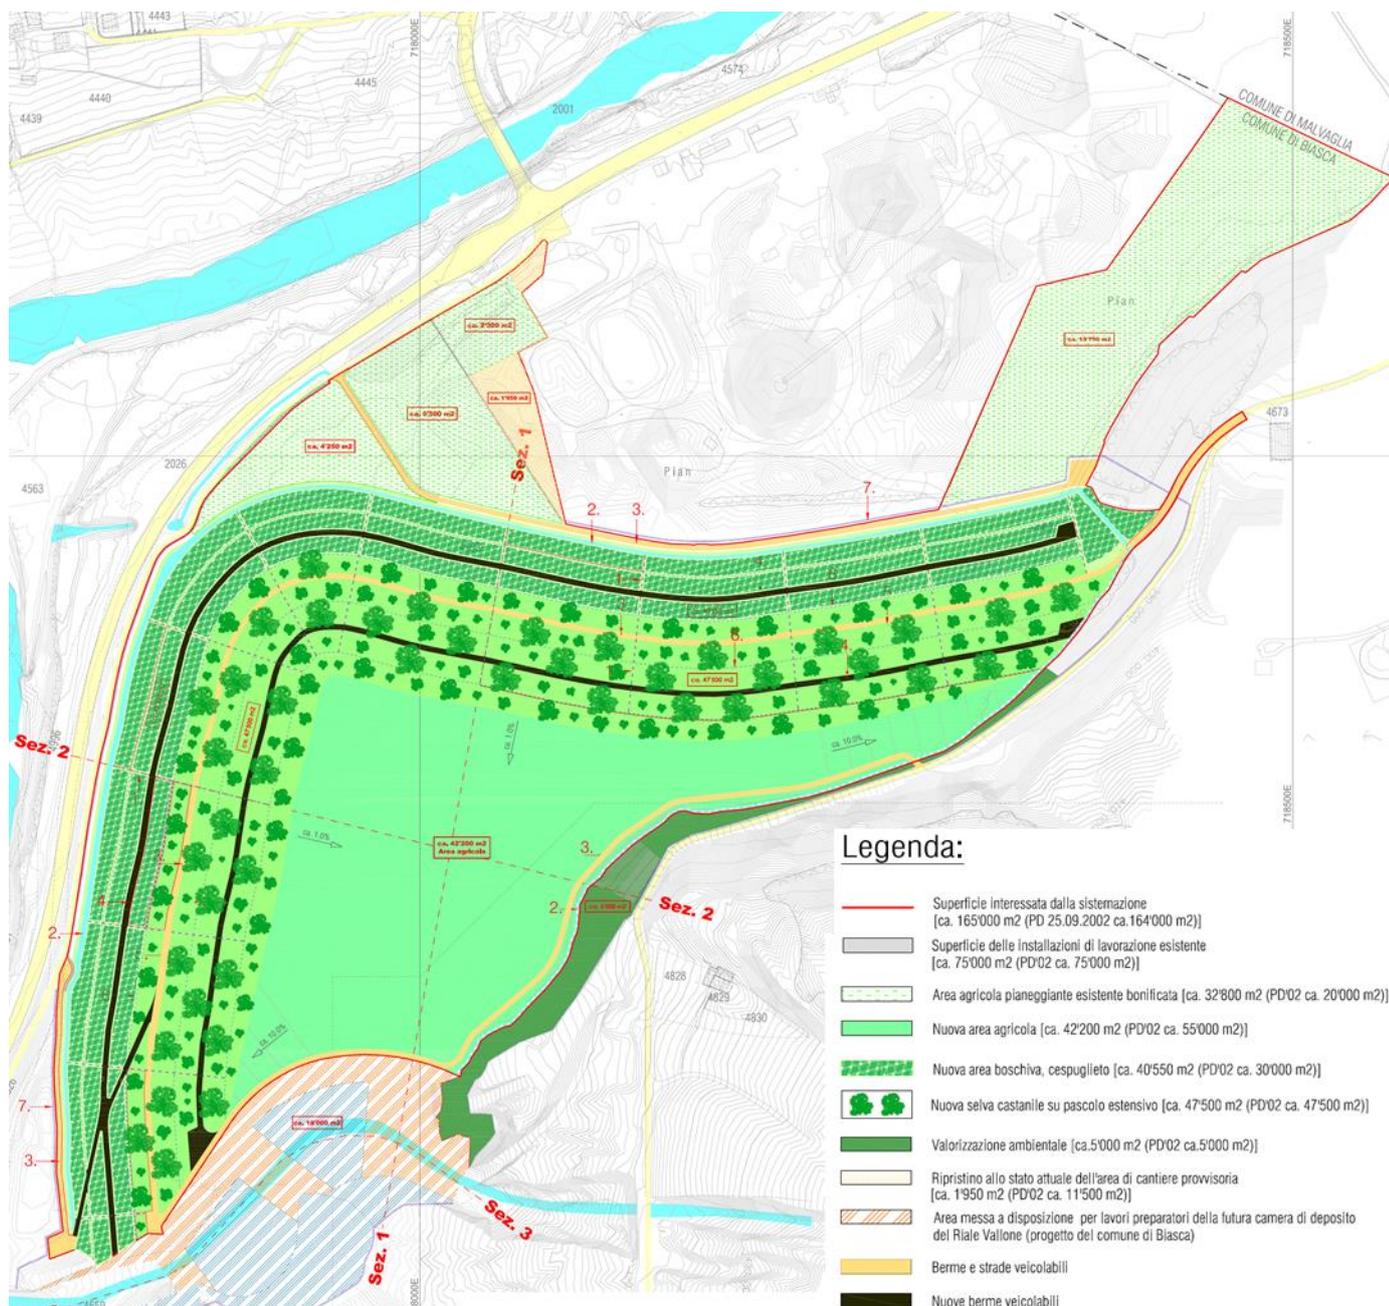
Sistemazione finale deposito ATG, pianta – rif. doc: 990/L609-202
